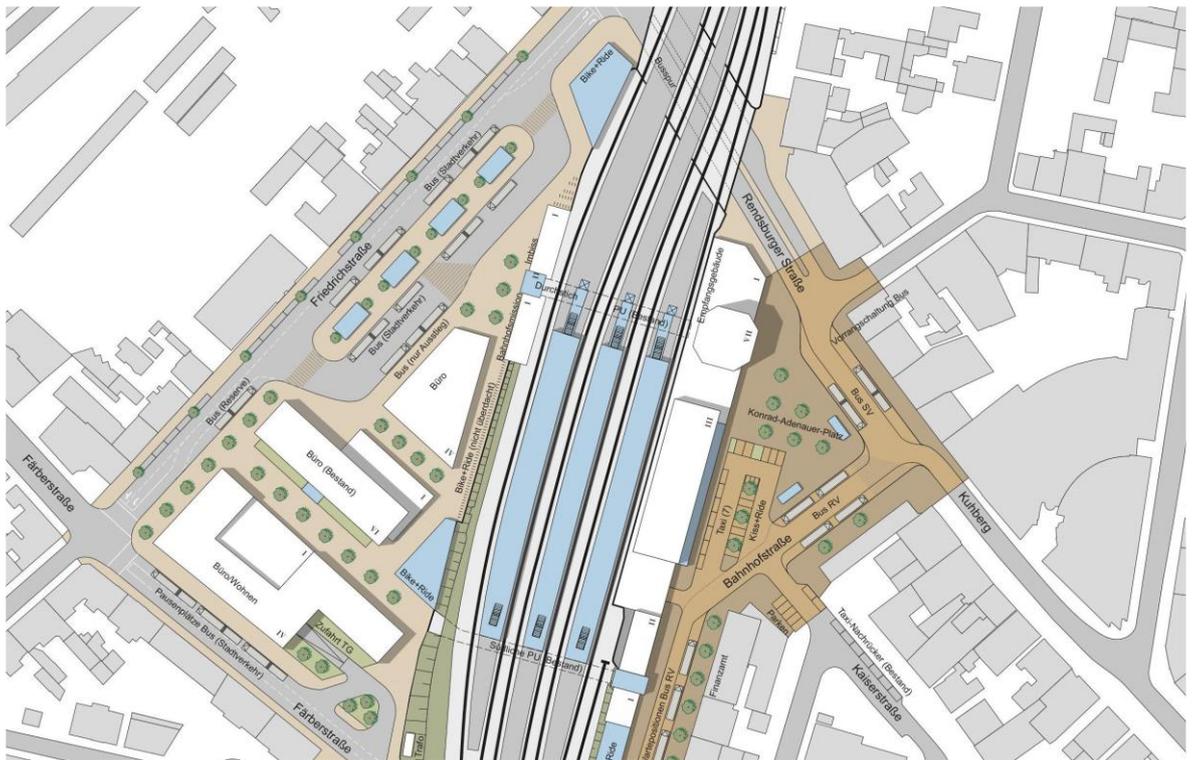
Ausschnitt des Lageplans I B - Erhalt Postgebäude / Bebauung Parkplatz
